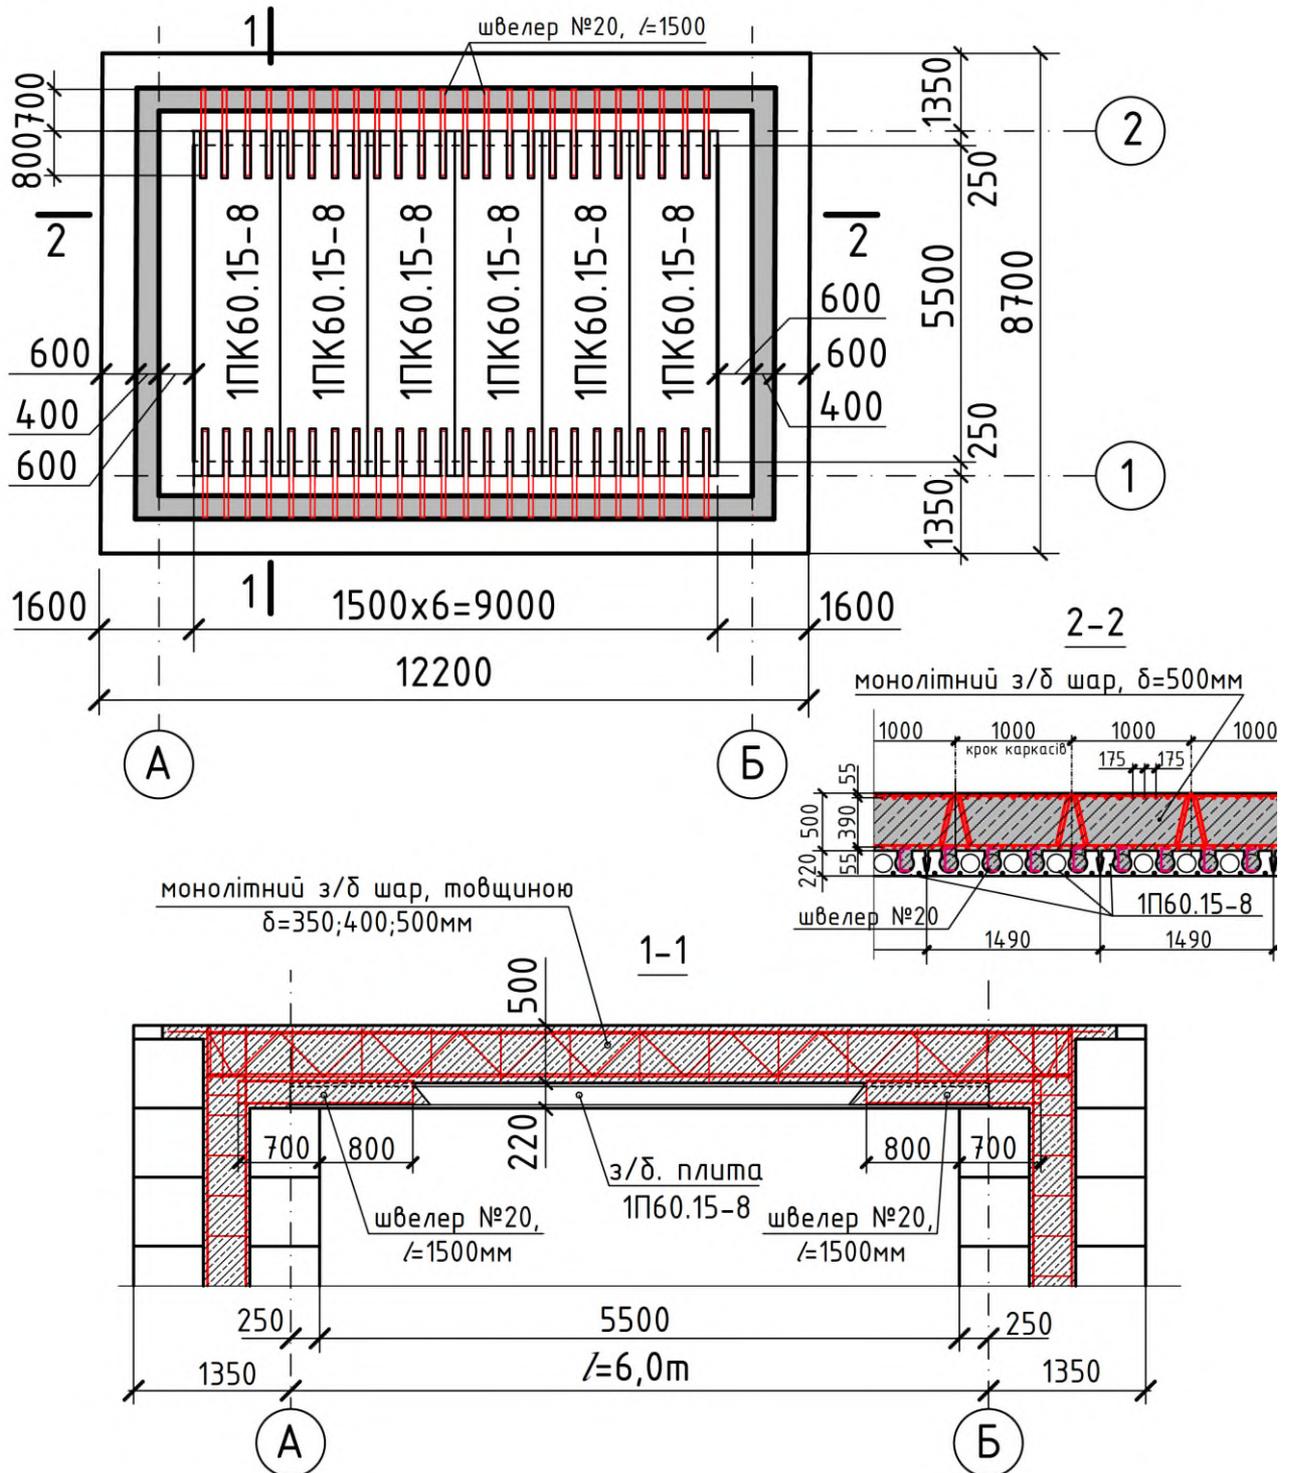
Конструктивне рішення збірно-монолітного перекриття за першим варіантом зі збірними елементами із залізобетонних багатопустотних плит марки 1ПК60.15-8
